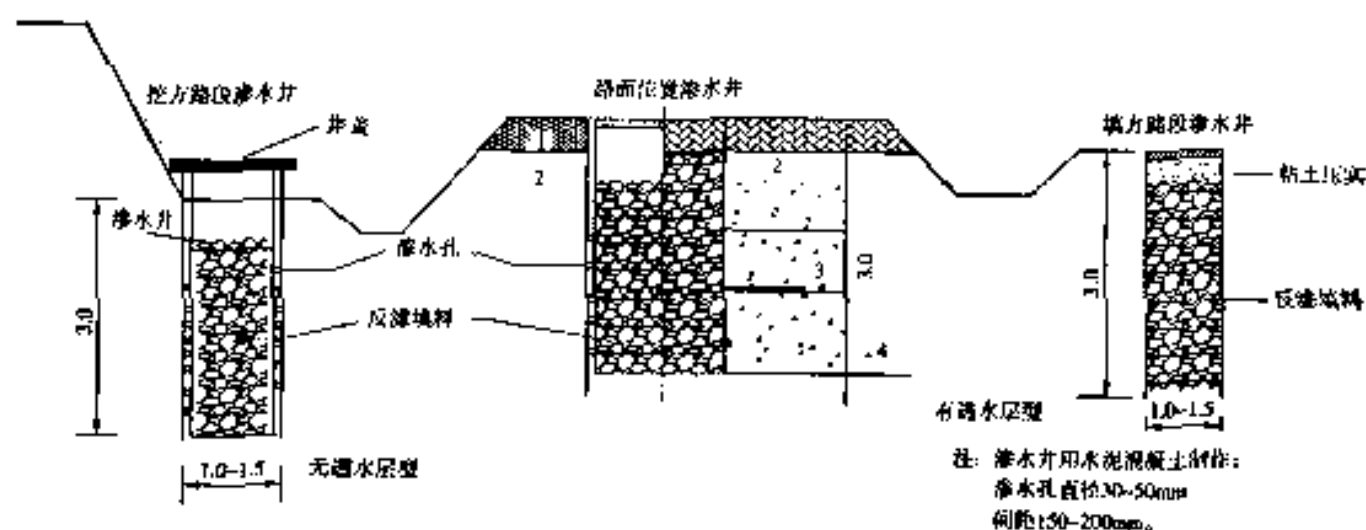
渗水井构造图(尺寸单位:m)
